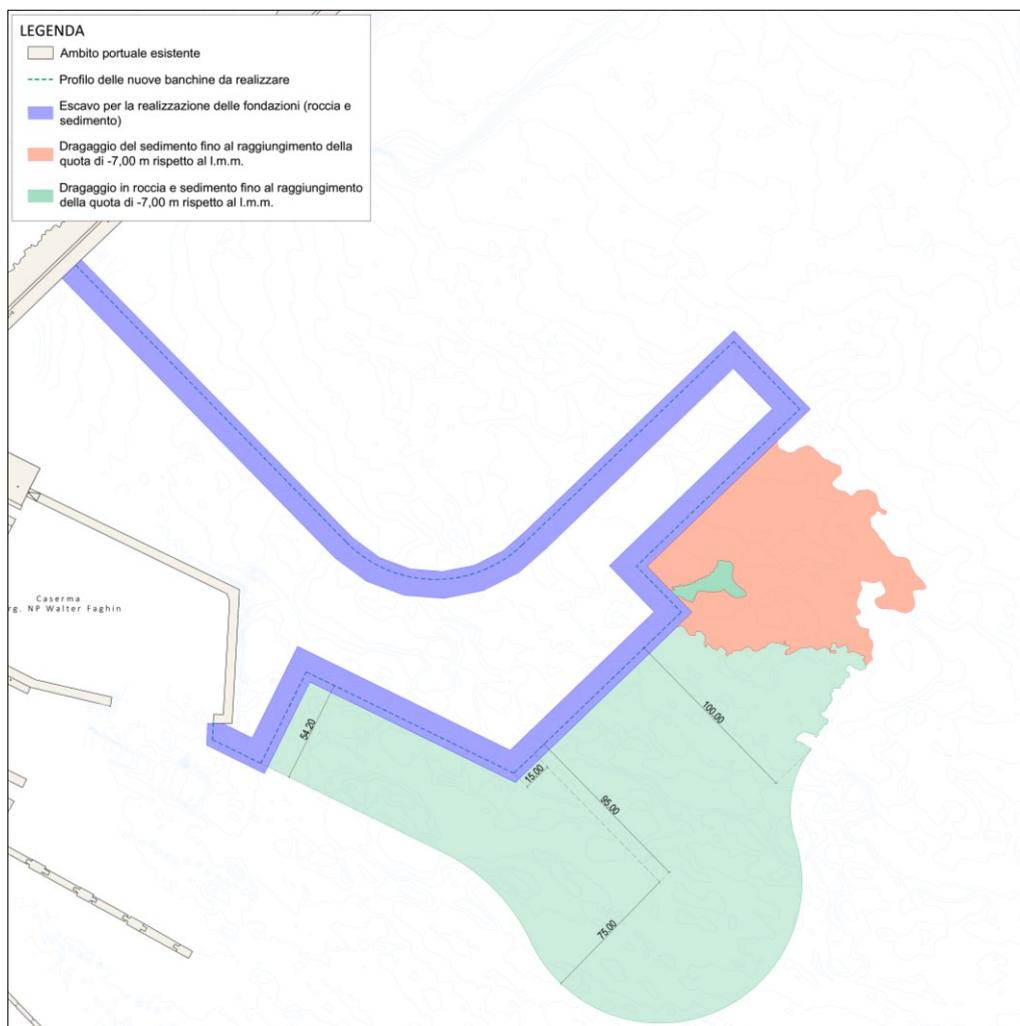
Planimetria del dragaggio (in blu è indicato l'escavo funzionale alla realizzazione delle fondazioni, in rosso il dragaggio del solo sedimento ed in verde il dragaggio in roccia)
